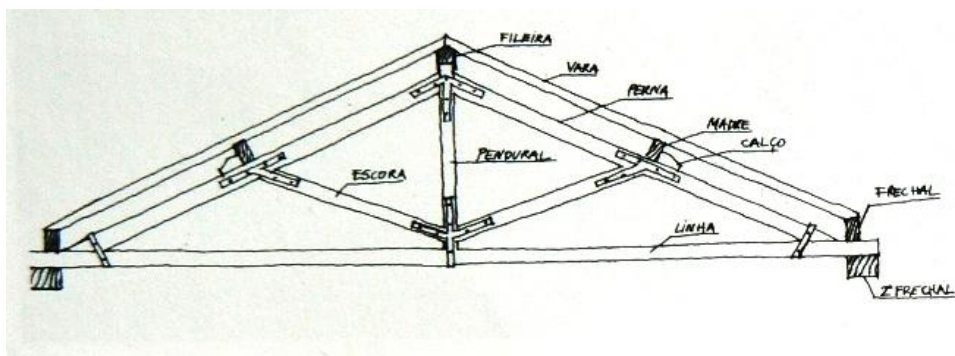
Pormenor de um tipo de asna utilizado. [10]
